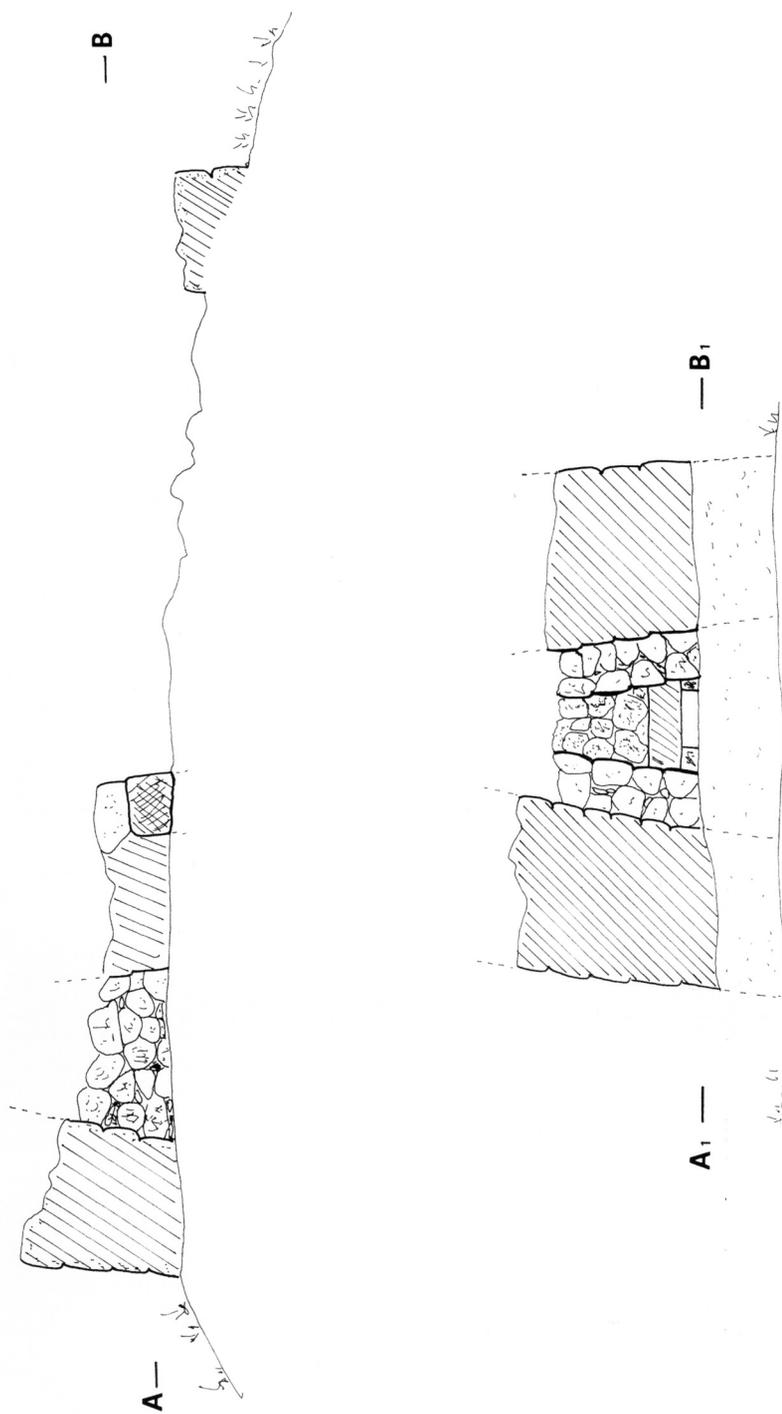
bis - *Massa Mei*: sezione longitudinale e prospetto della torre centrale.
